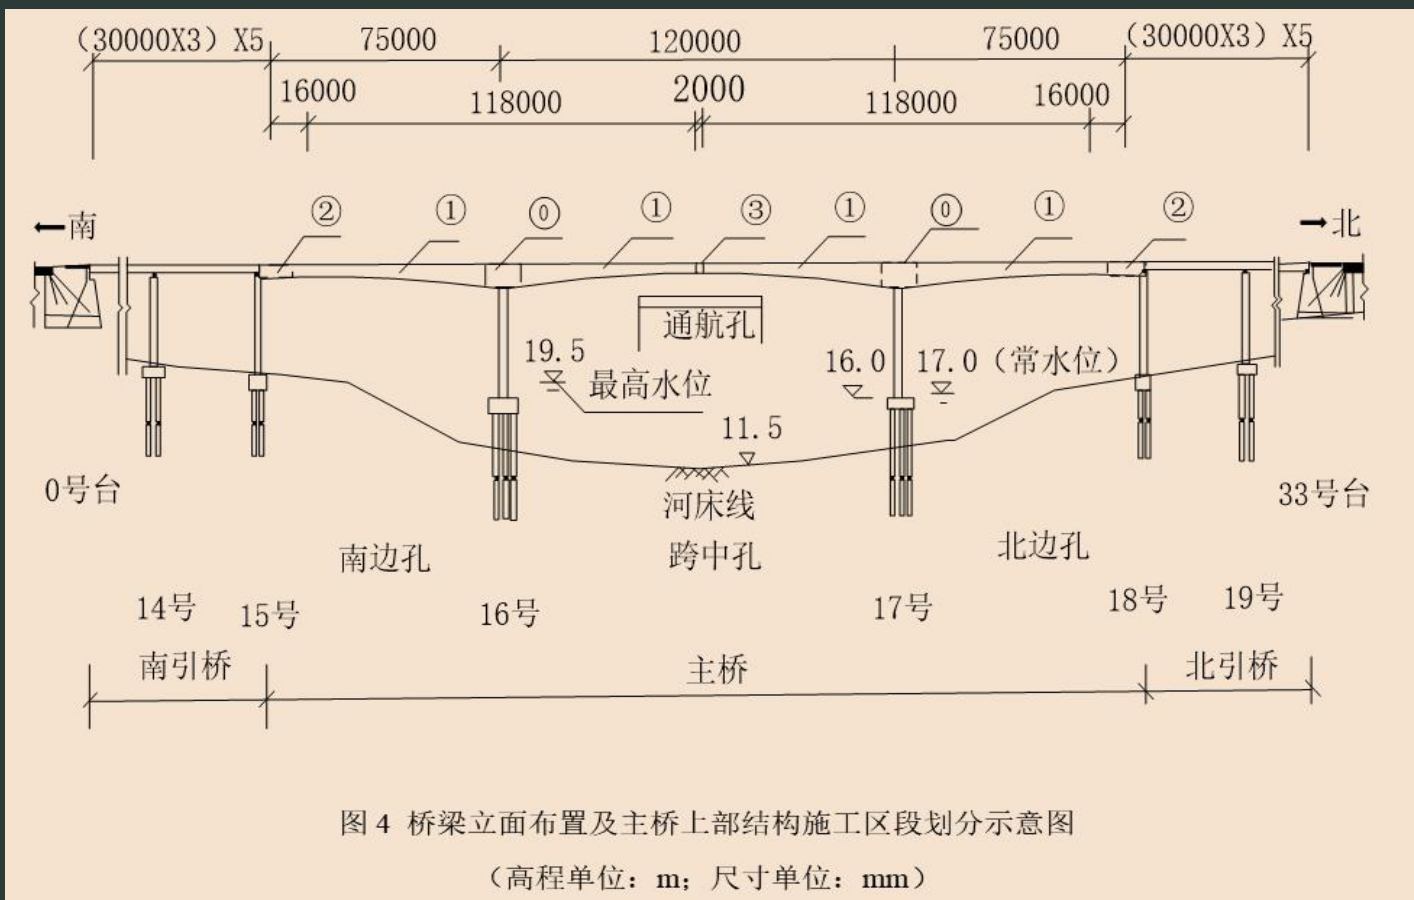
桥梁立面布置及主桥上部结构施工区段划分示意图
